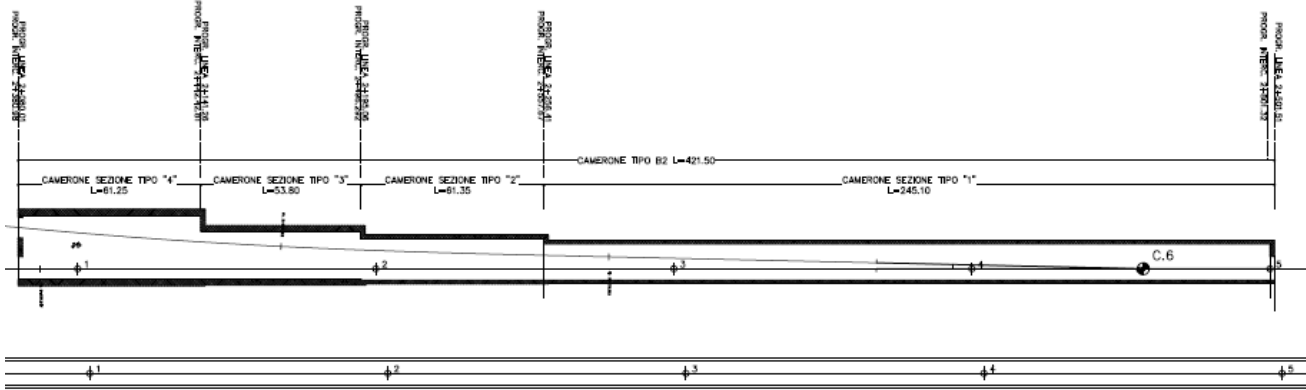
Sezioni tipo camerone previste da Progetto Definitivo
